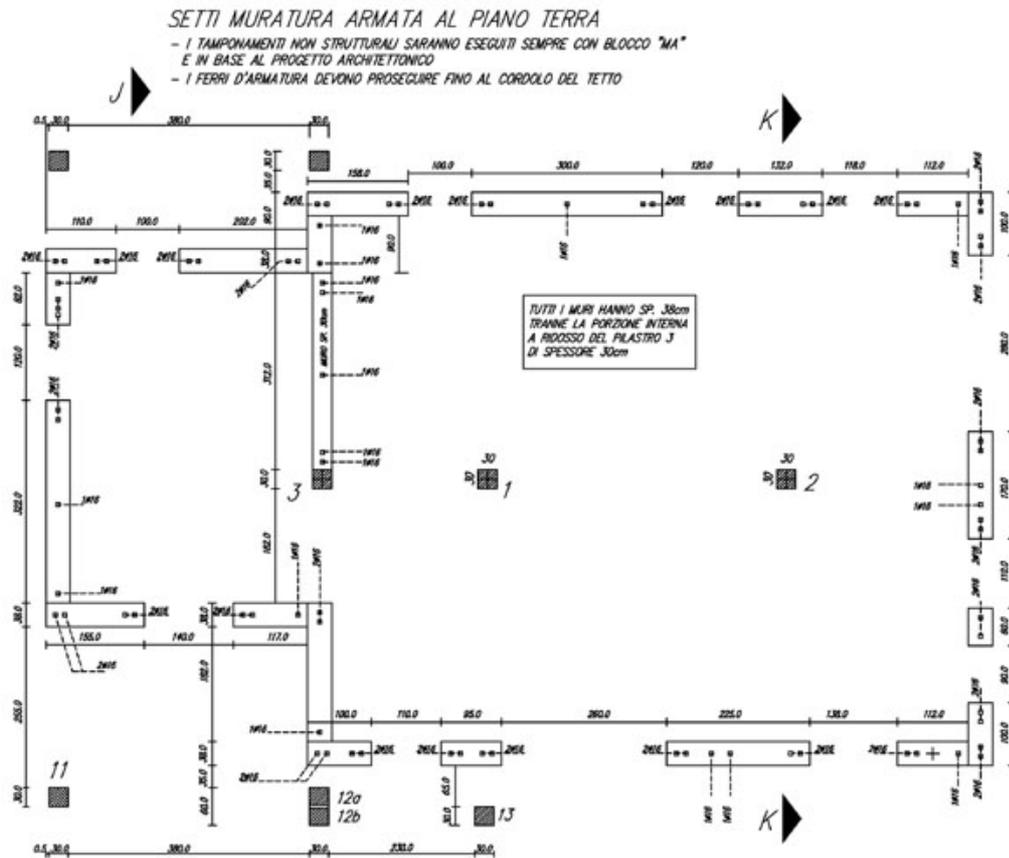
Pianta dei setti murari resistenti ed indicazione della disposizione delle armature verticali.
